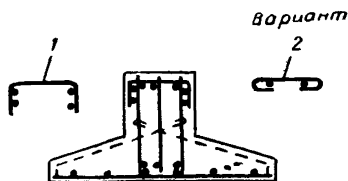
Армирование ребер ленточного железобетонного фундамента сварными каркасами
